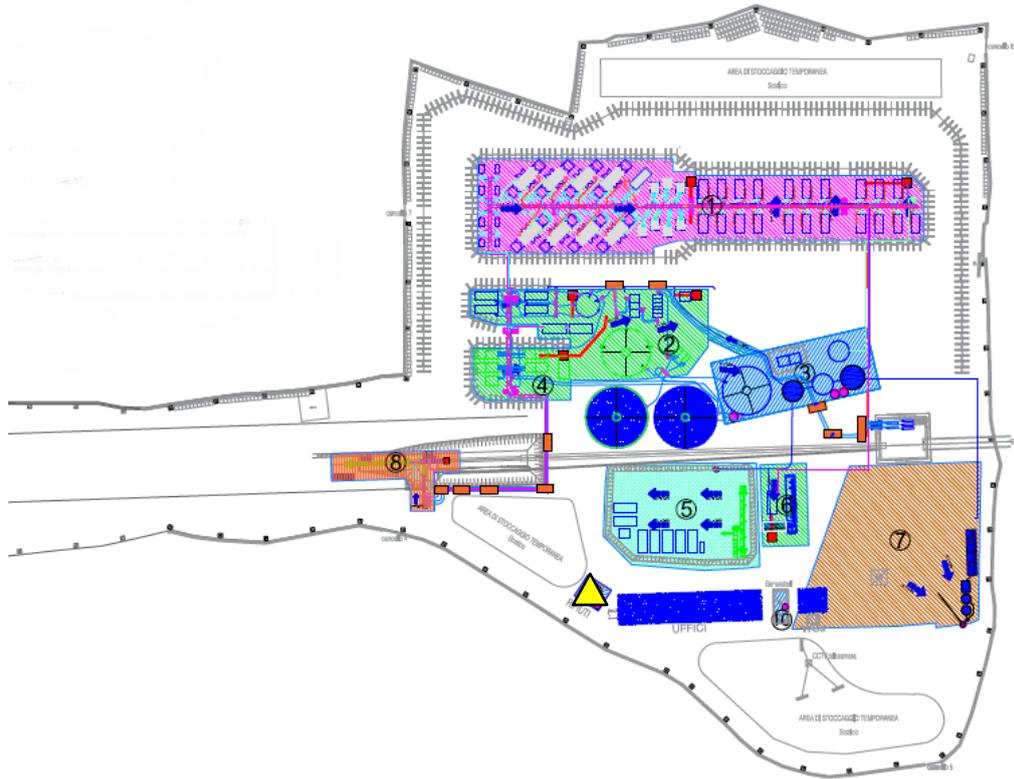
Layout dell'area di cantiere del tracciato dell'OPLI
